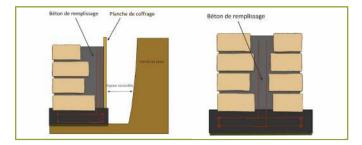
Schéma de principe d'un mur de soutènement et d'un mur en béton banché de pierres (Dessin de Cédric Houel)
